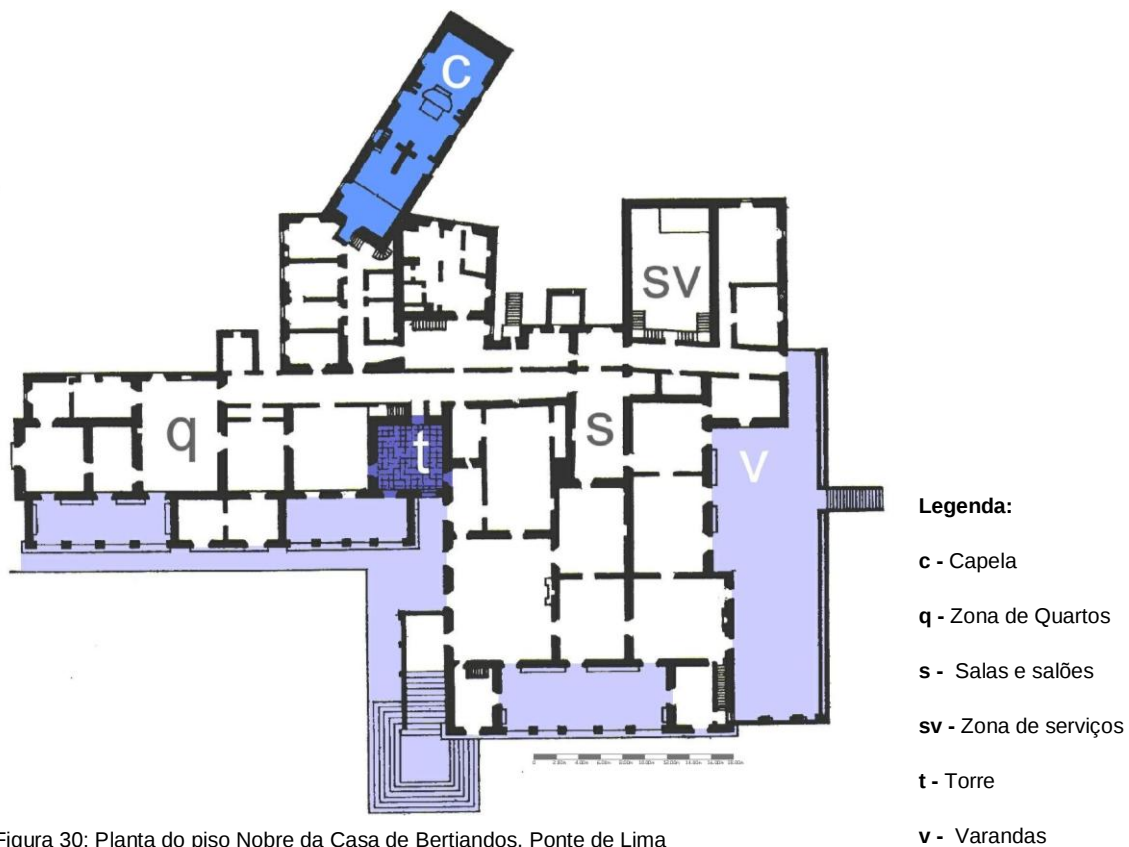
Planta do piso Nobre da Casa de Bertandos, Ponte de Lima
